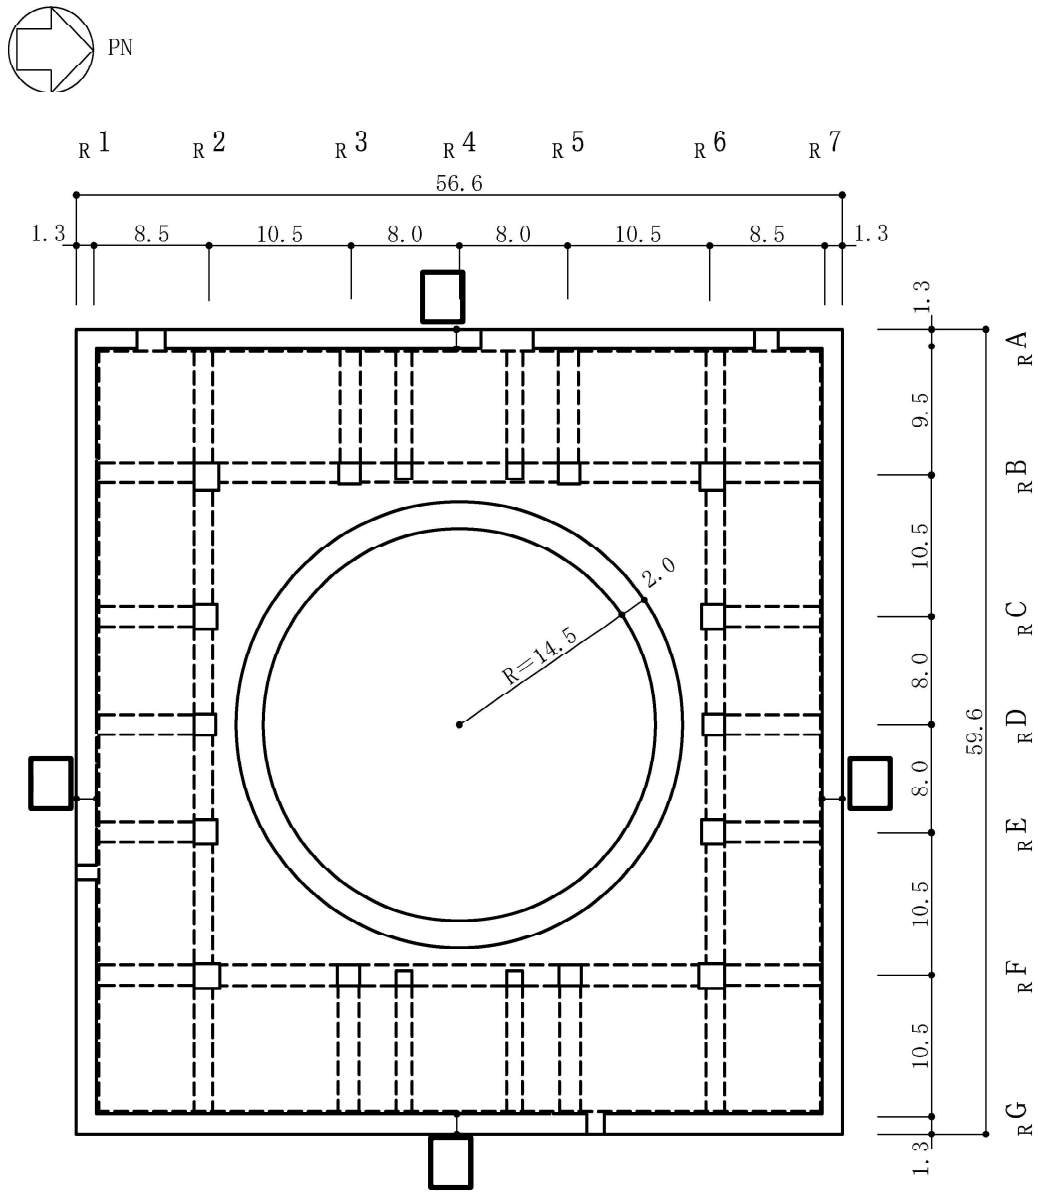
原子炉建屋の概略平面図 (B1F, T.M.S.L. 4.8m) (3/9) (単位 : m)
